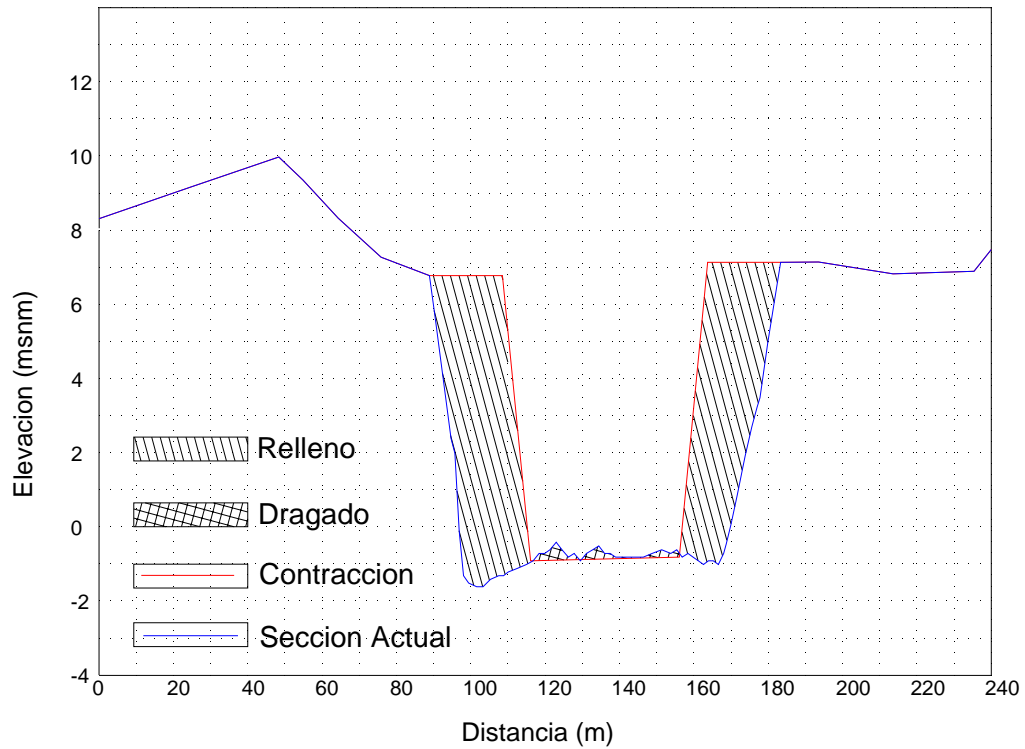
Sección transversal km 43 - Contracción No. 2
